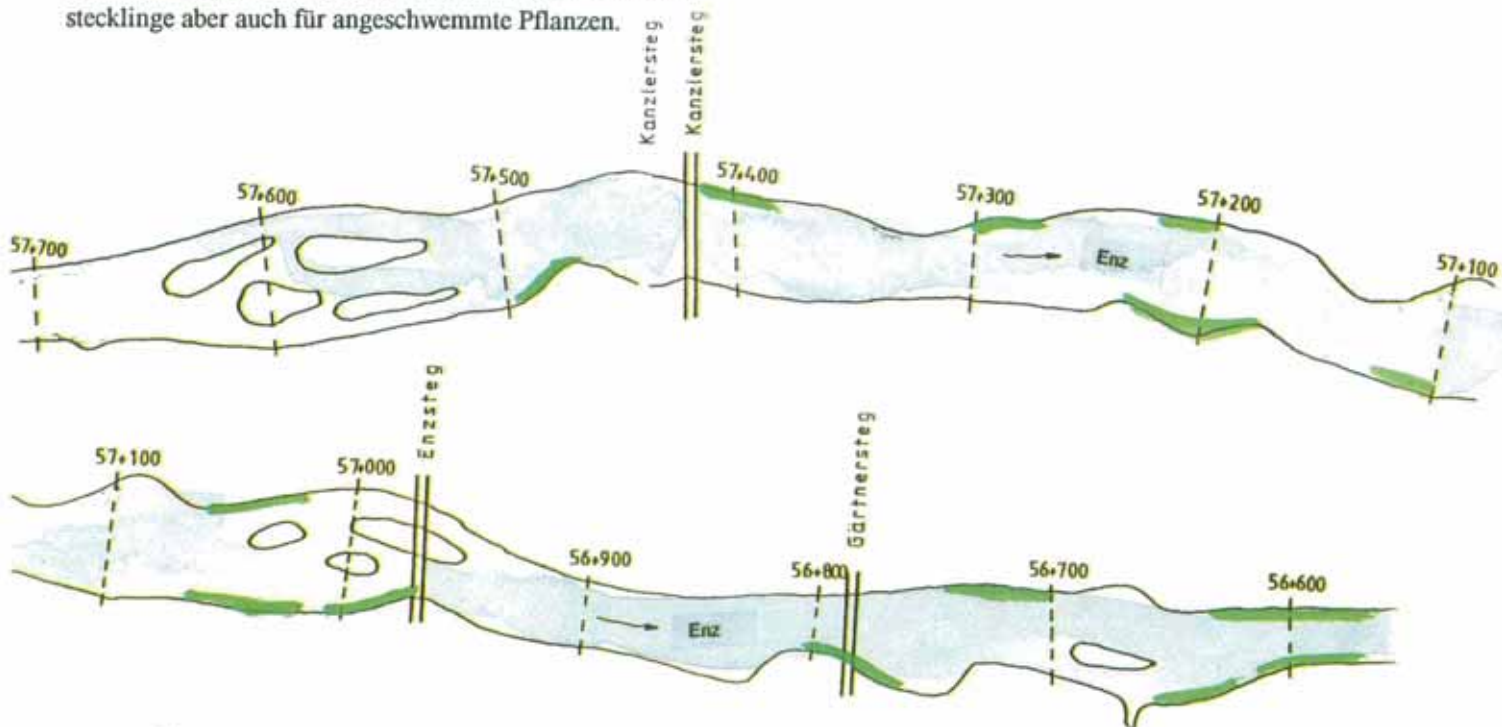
Übersichtslageplan: Abschnitte mit Weidensteckhölzer und Stechhölzer (■).
